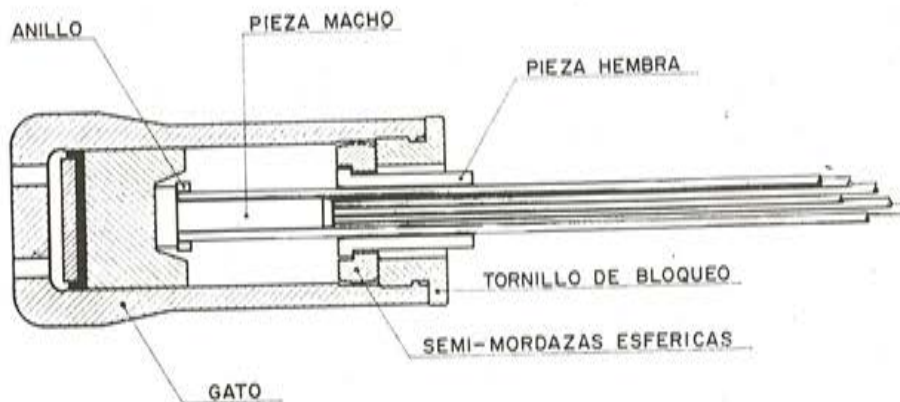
Gato de acoplamiento (peso, 15 Kg).
